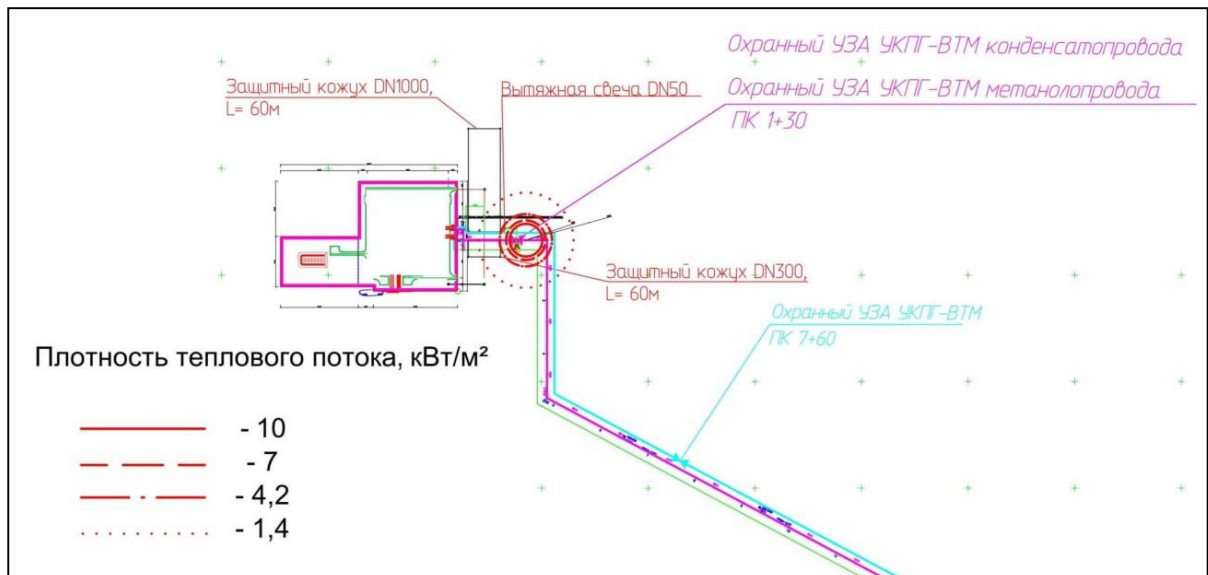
План наиболее опасной аварии на газопроводе в районе ВТМ
